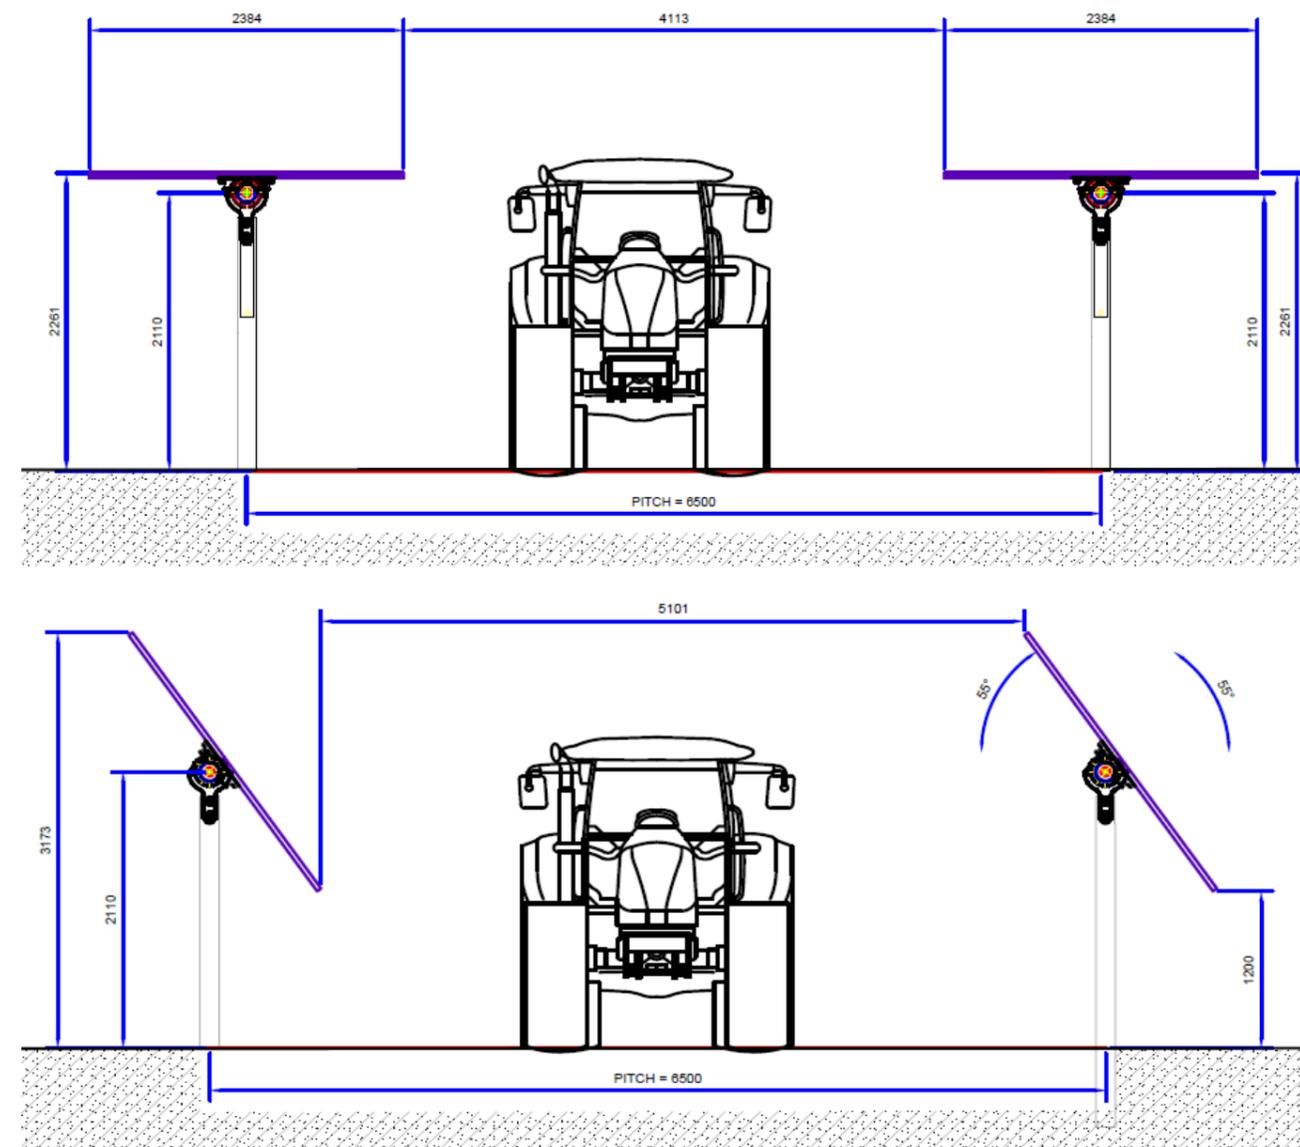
Coupe de principe des trackers (Source : Valorem)
